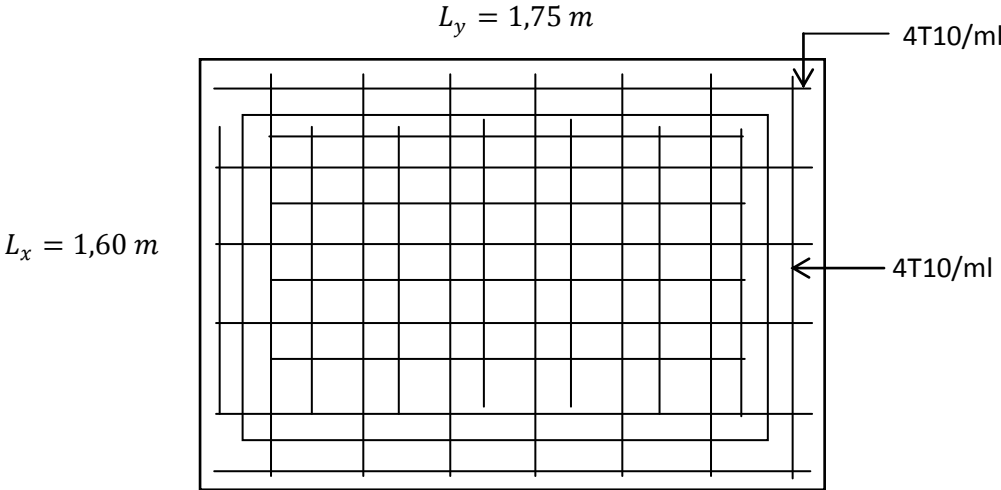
Ferrailage inférieur de la dalle de l’ascenseur
